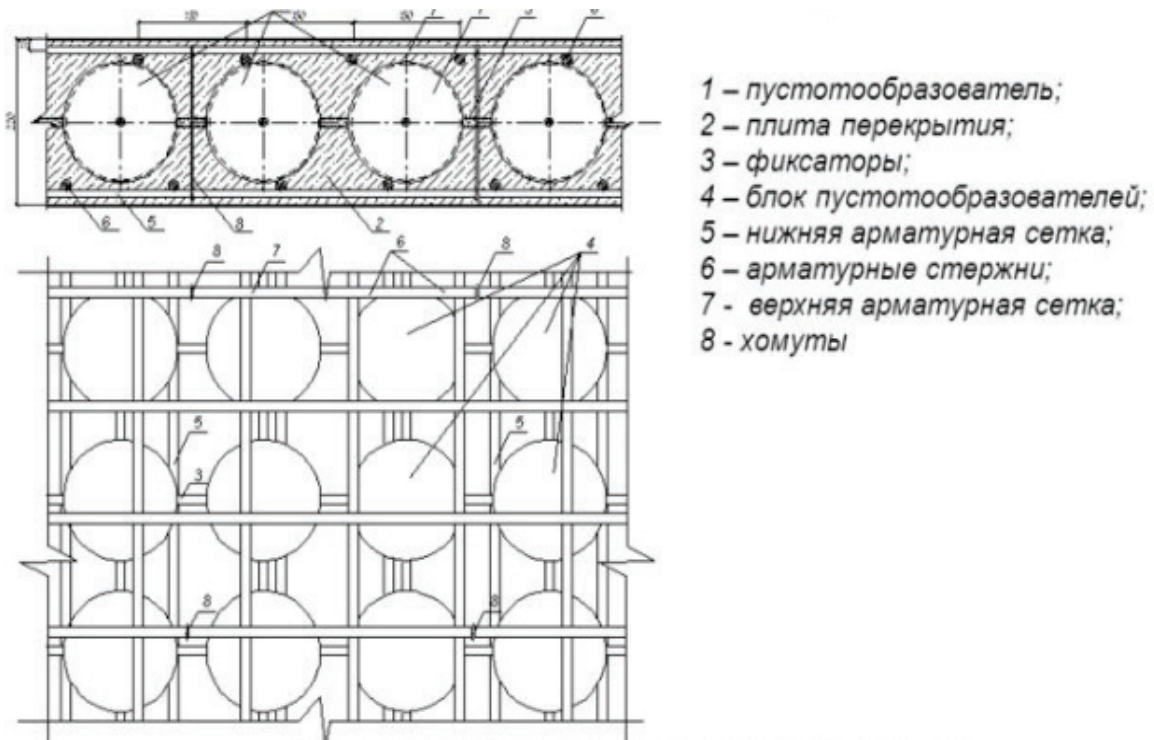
Схема устройства блока пустотообразователей в плиту перекрытия
